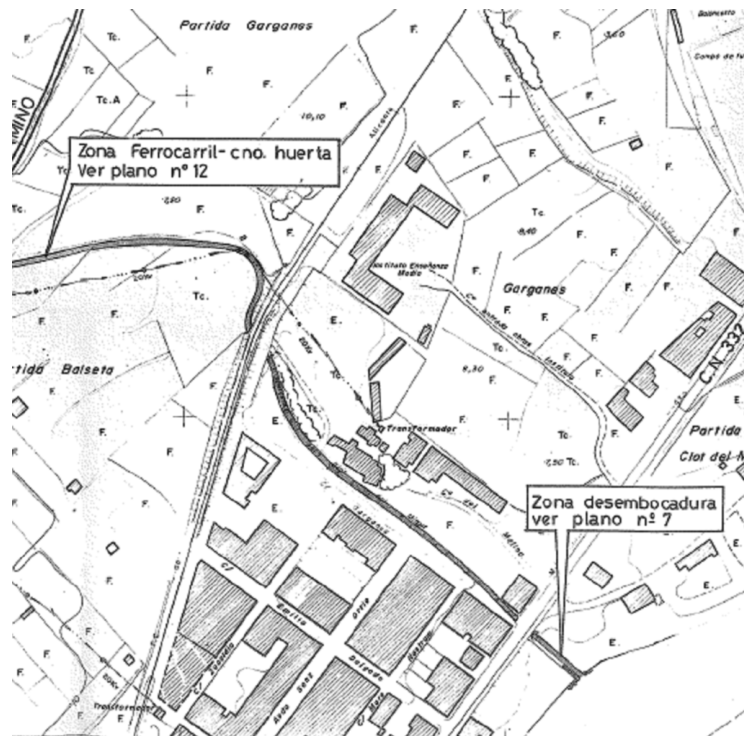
Extracto de la planta de zona de obras del Proyecto de Encauzamiento Barranco Clot del Mingot Fase 2, en Altea
